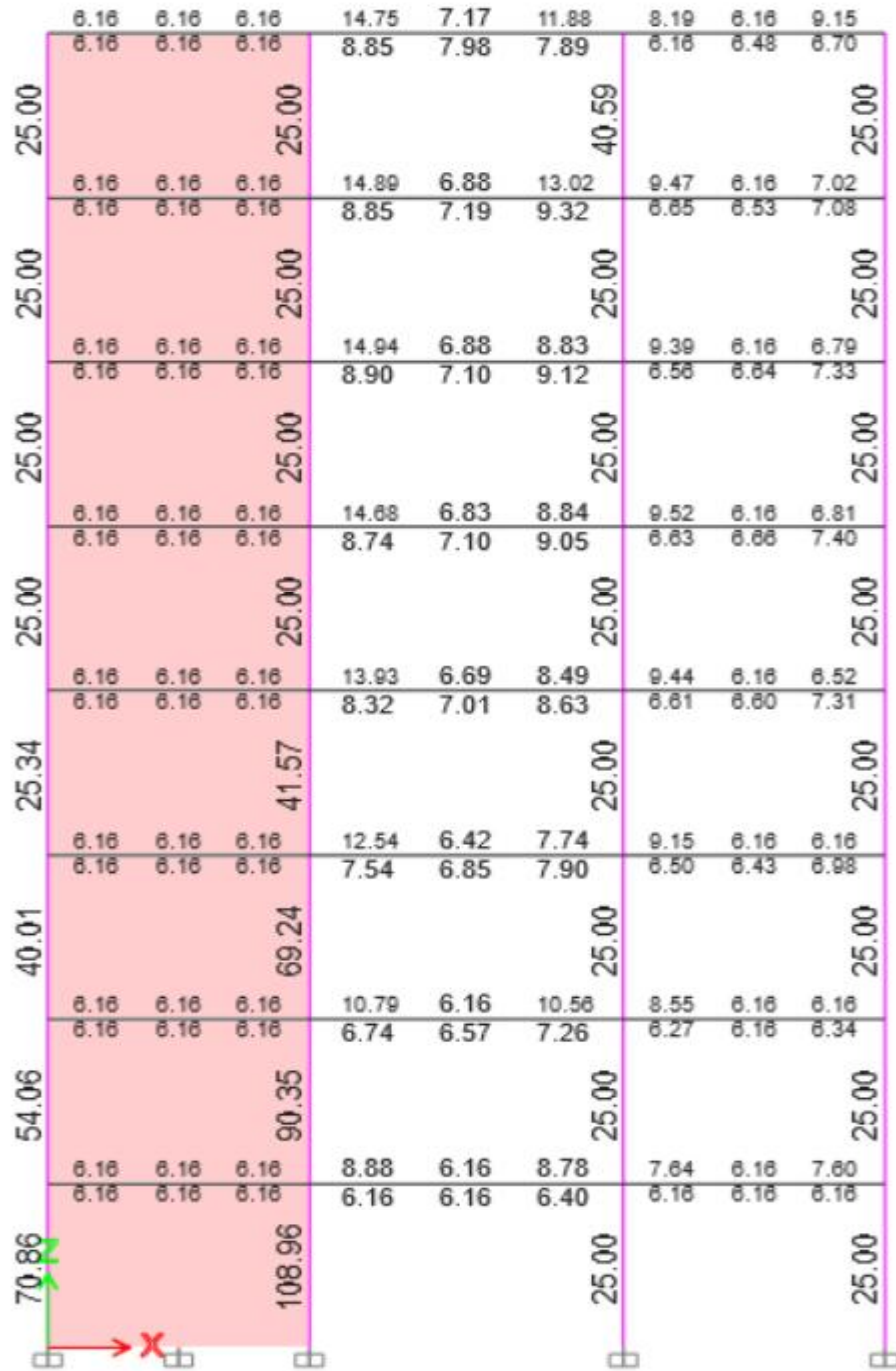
Refuerzo Longitudinal Columnas cm² - Estructura 8 Pisos
